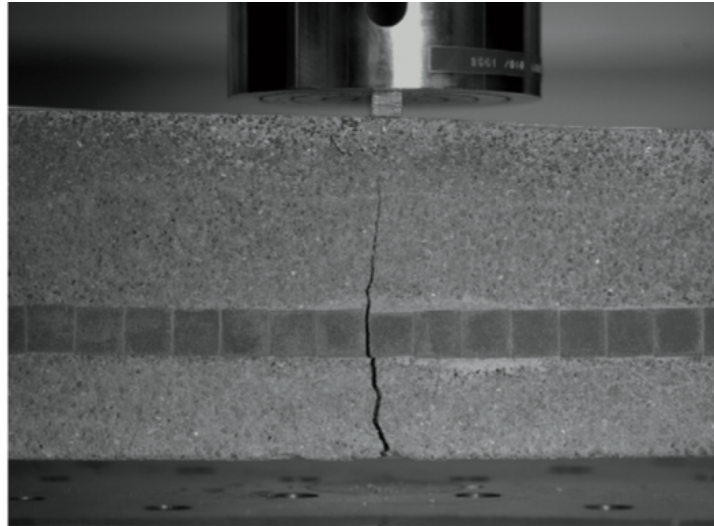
Grieta observada a simple vista en una viga [10]
